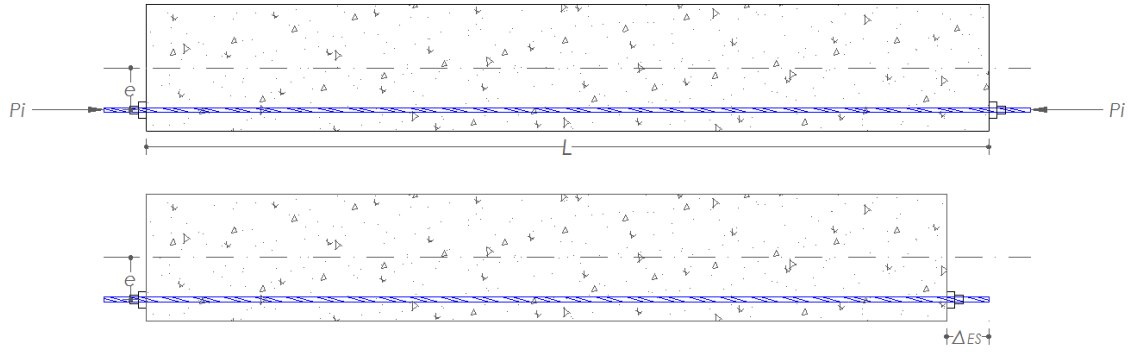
Pérdida de esfuerzo por Acortamiento Elástico del Hormigón
